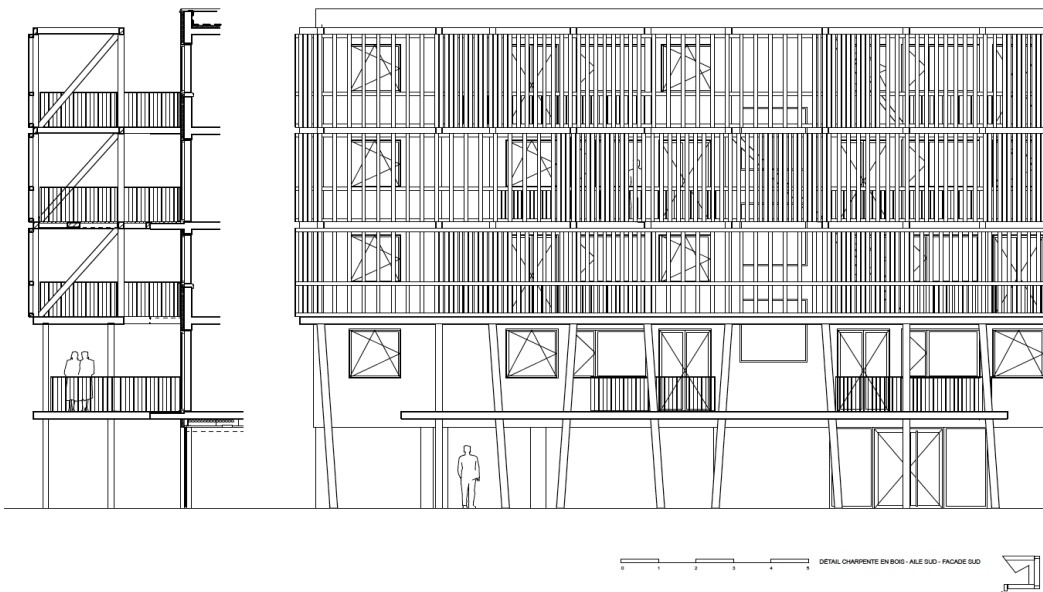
Imágenes y planimetría del desarrollo de la nueva piel abierta de la manzana B2 de Terres Neuves, que prolonga hacia el exterior las salas de estar de las viviendas. Su construcción se resuelve con una base de forjado y pilotis de hormigón armado, sobre la cual se eleva una estructura de madera. Esta estructura es independiente de la del bloque, si bien se espera que se comporte solidariamente al estar unida a ésta mediante conectores entre forjados, asimilando los voladizos de los antiguos balcones. Fotografías de Arthur Péquin. Fuente: Atelier King Kong
